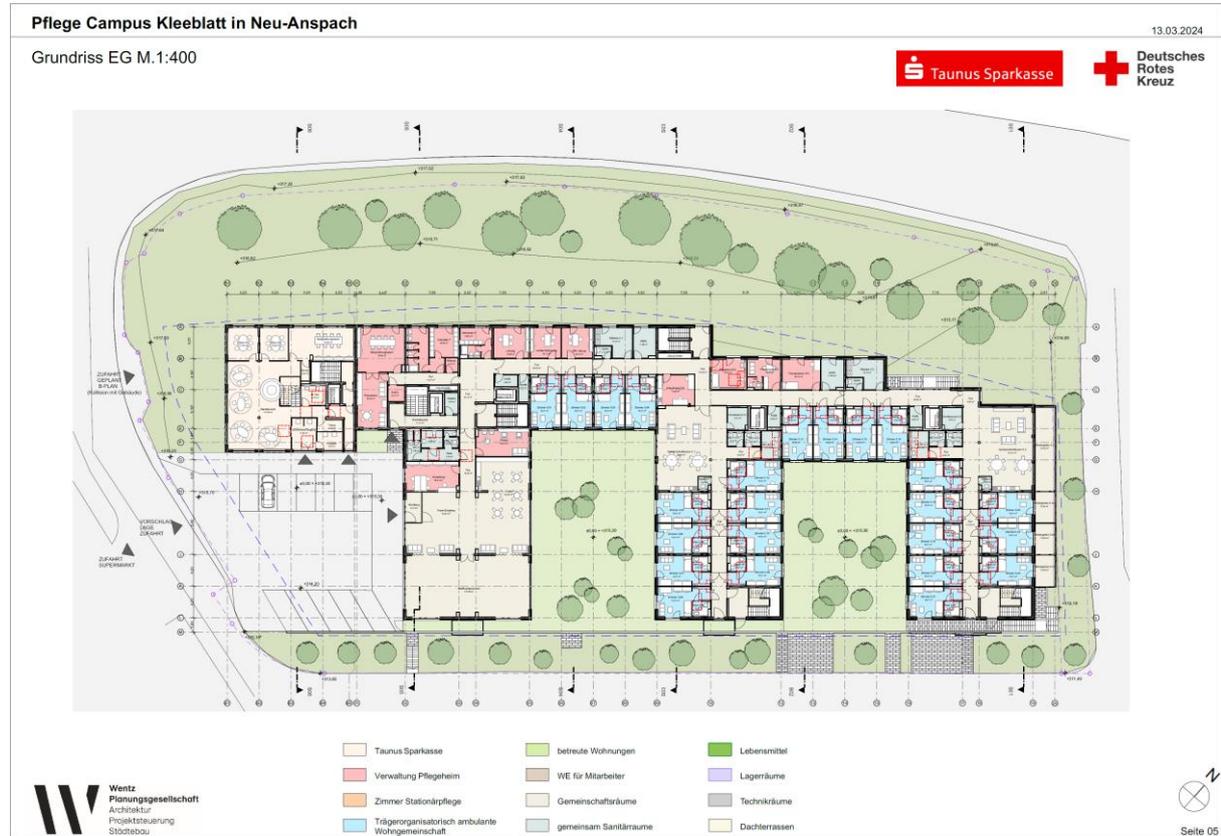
Grundriss EG, unmaßstäblich
